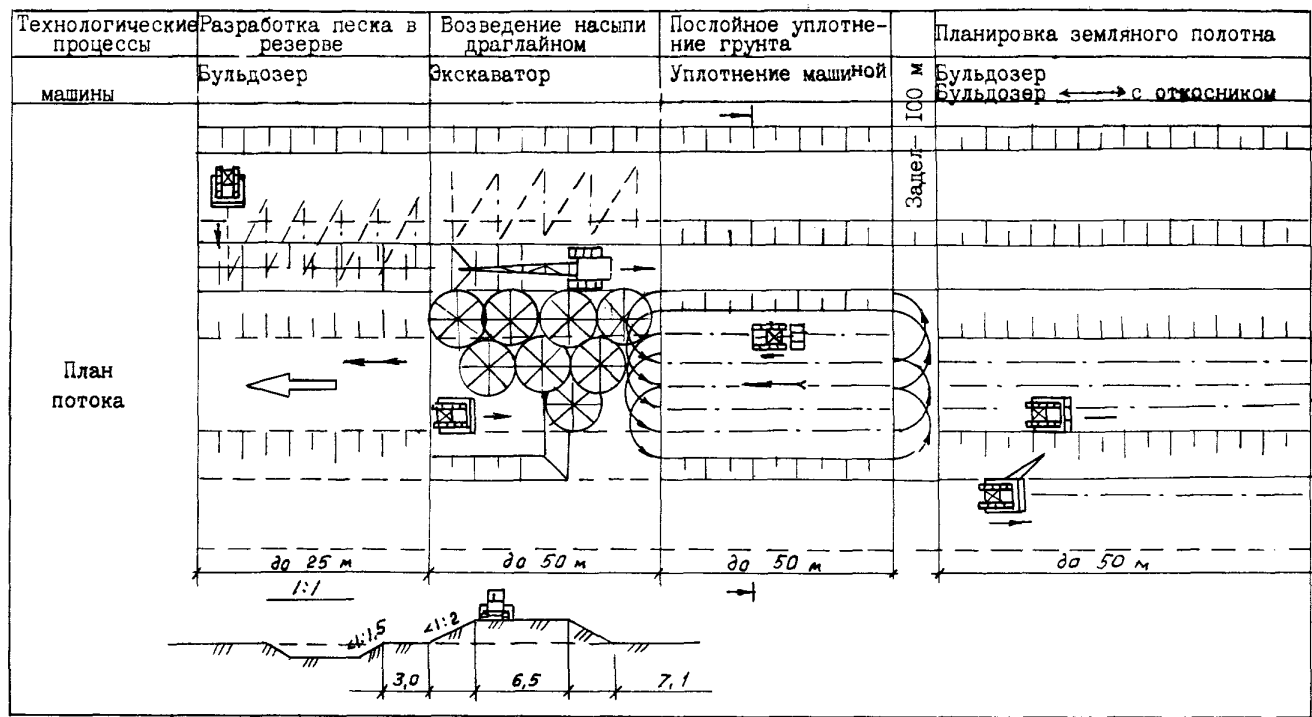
Схема возведения насыпи высотой более 4 м с разработкой грунта в резерве бульдозером
